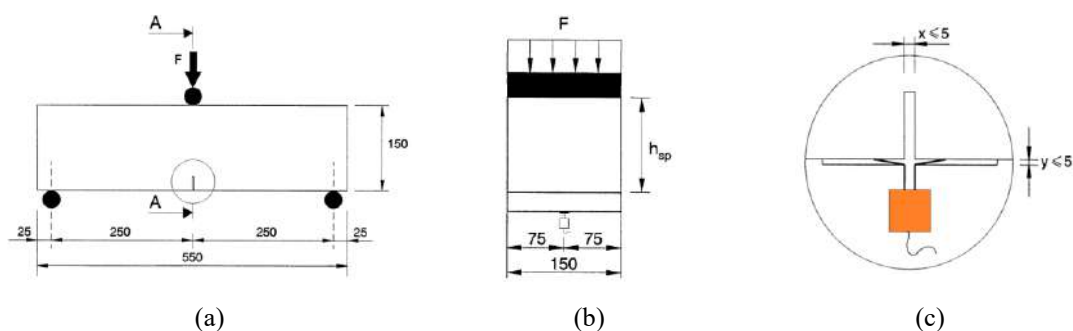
Ensaio de tração na flexão em 3 pontos: (a) Setup do ensaio, (b) Corte A-A, e (c) detalhe das dimensões máximas do entalhe e do encaixe do clip gauge (em laranja) [123].
